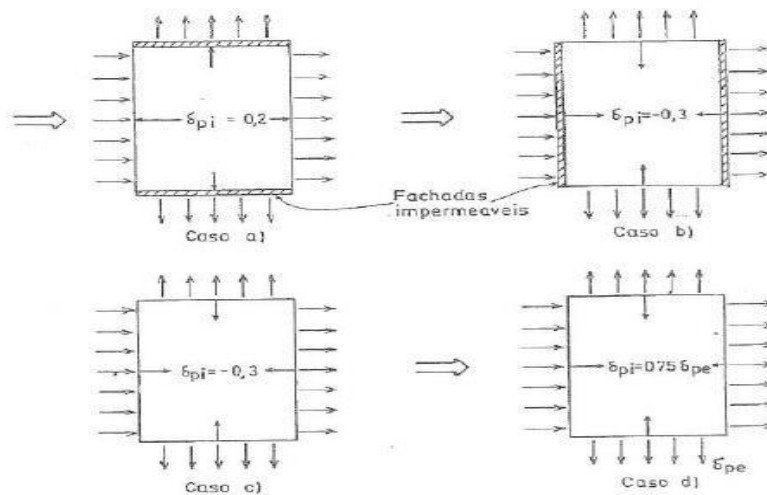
Coeficientes de pressão interior em edifícios de planta retangular das fachadas
